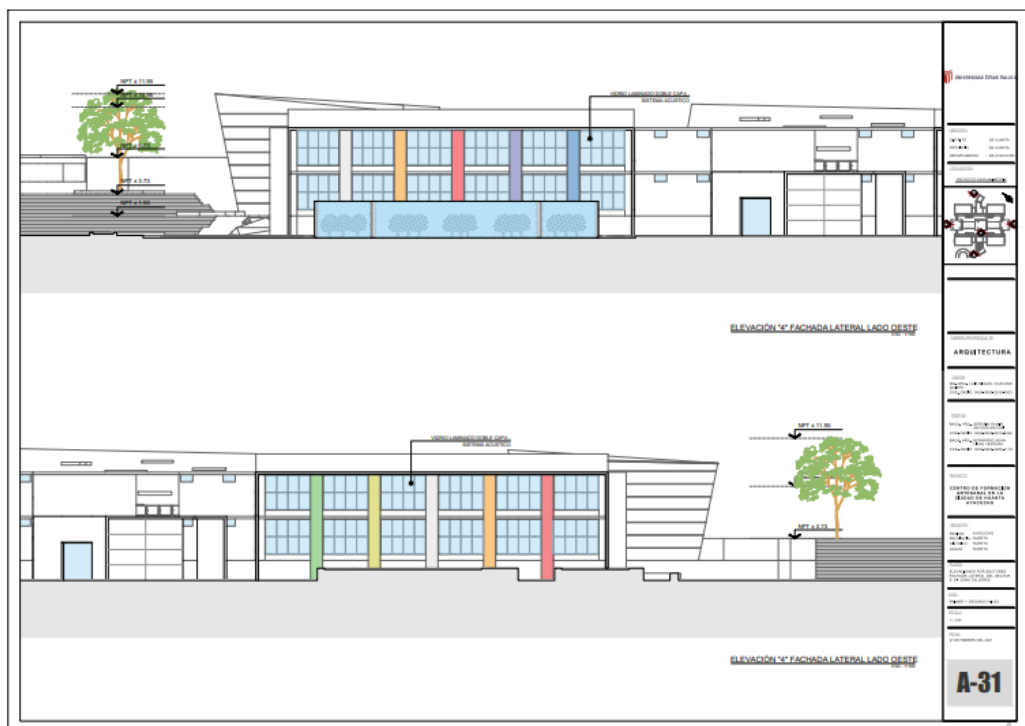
Elevaciones del lado oeste – fachada lateral derecha escala 1/100.
